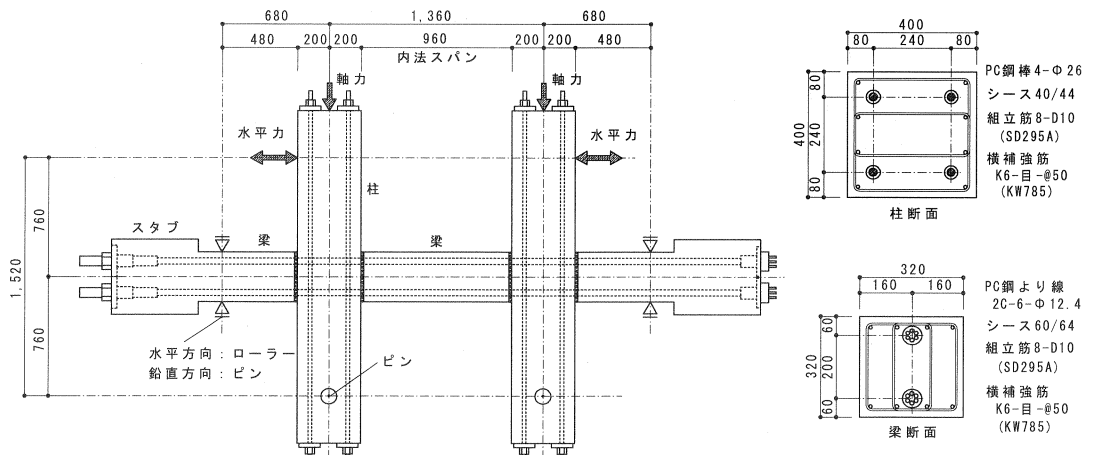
試験体の形状および柱梁断面 (試験体記号 No. 1 の場合)
